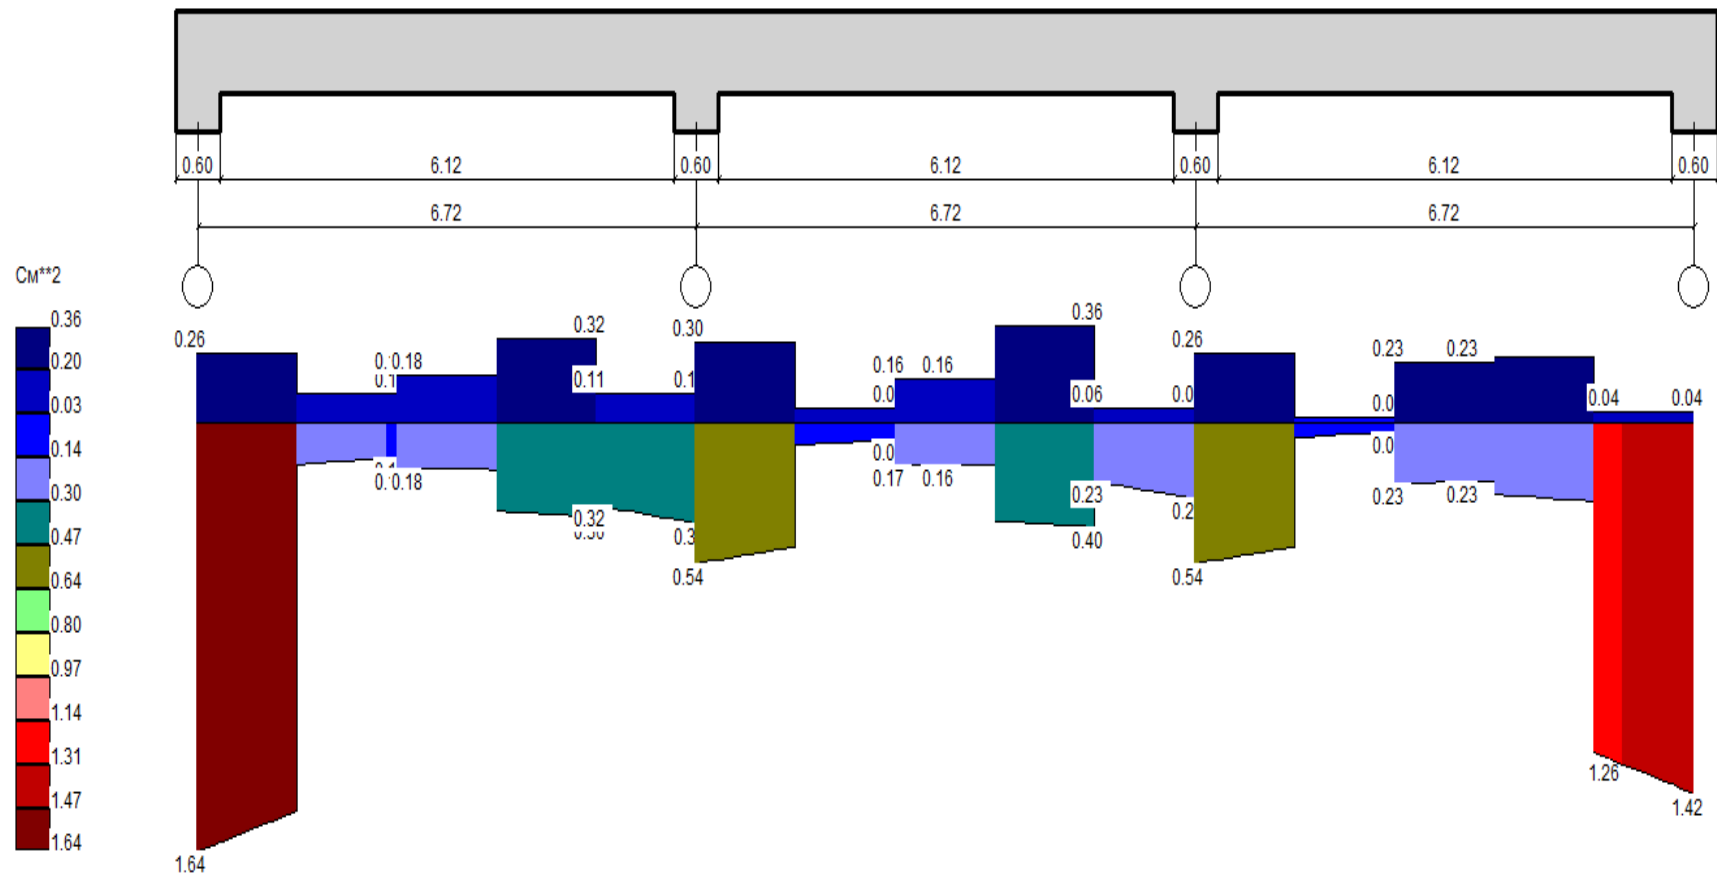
Варіант будинку з балочно - плитним перекриттям. Балка Б1-3. Теоретична еюра поперечного армування.
